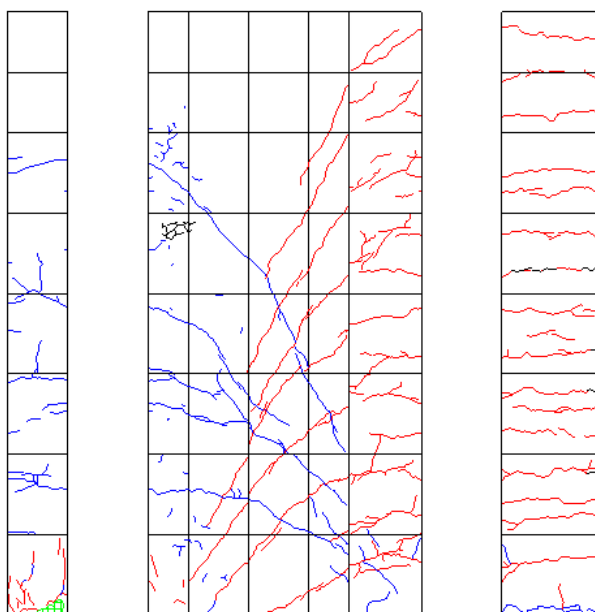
R=1/50②ひび割れ図
